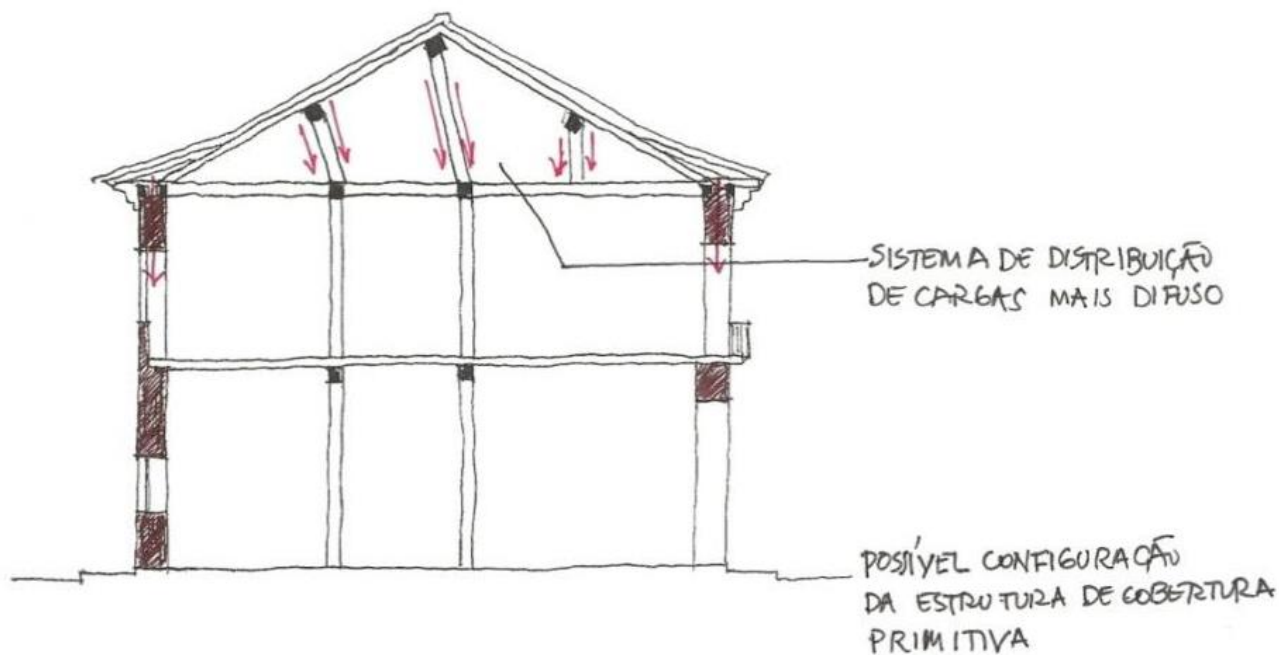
Possível Configuração da Estrutura de cobertura primitiva. Fonte: Desenho M. Carrilho.
